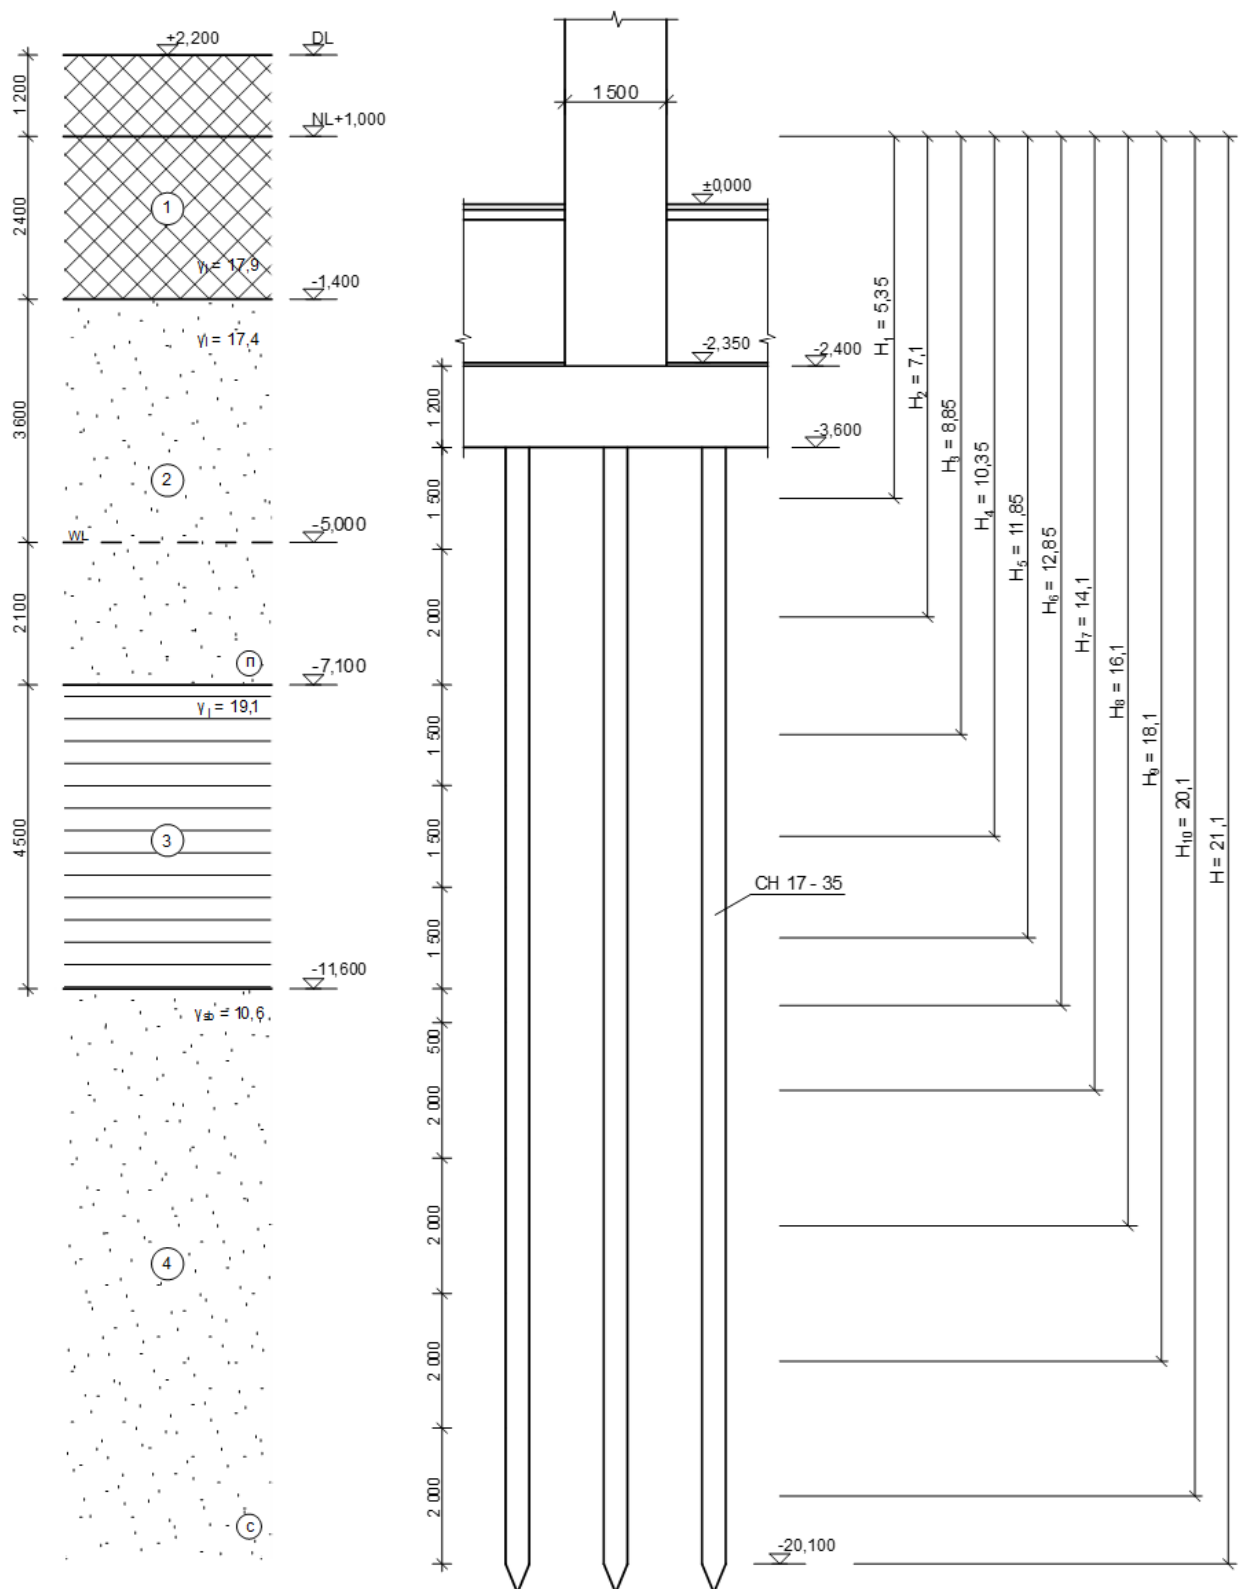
Положення у ґрунті і розрахункова схема фундаменту з забивних палів
